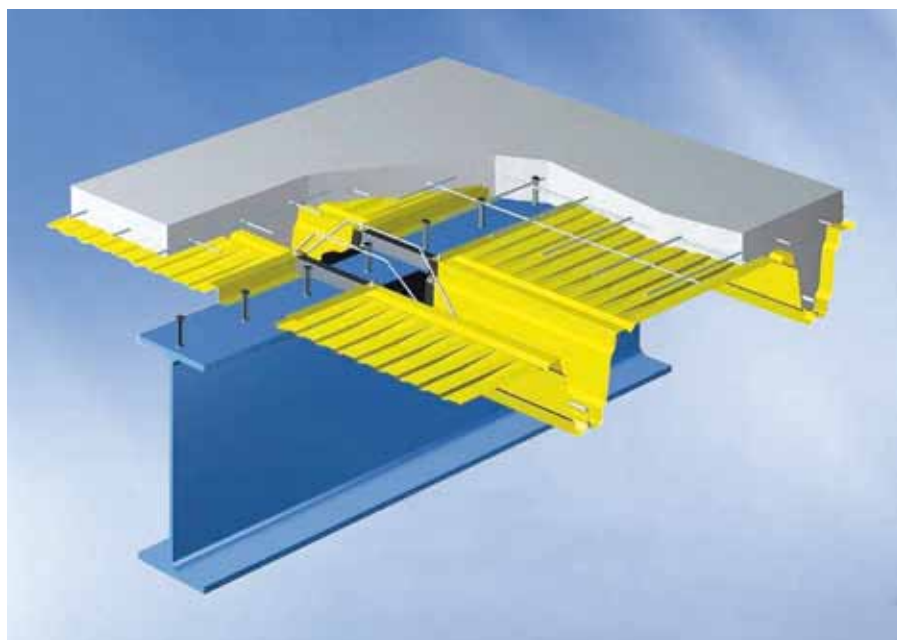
Detalle del sistema de forjado Hoesch Additif sobre viga de acero
